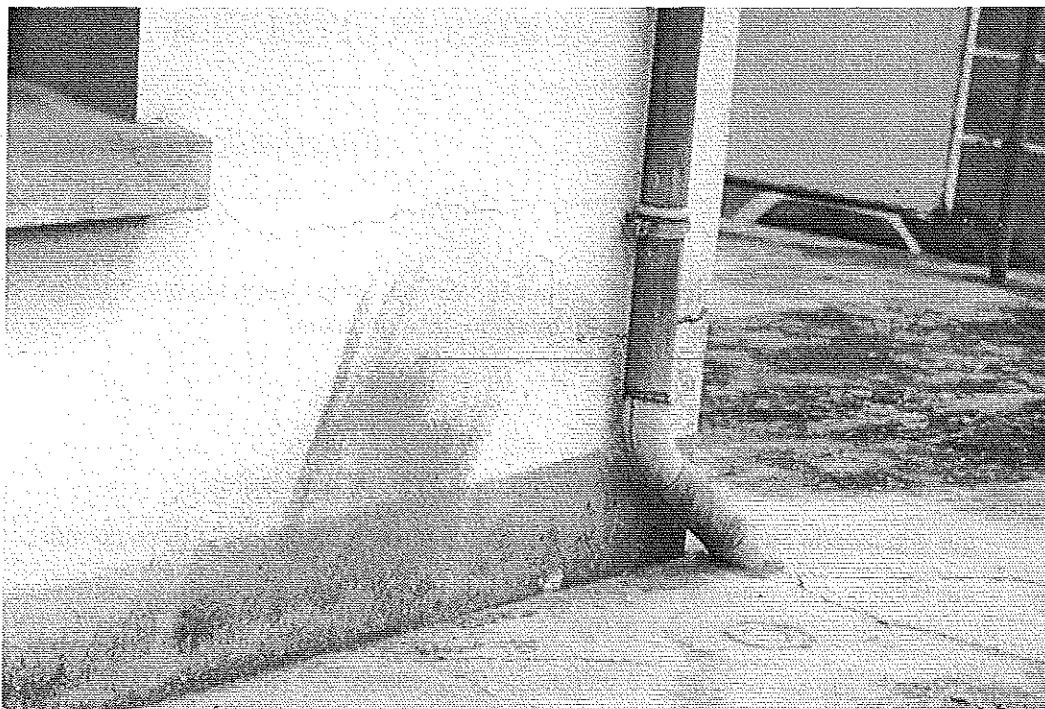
Retour de façade. La fissure se poursuit et rejoint l'appui de baie après un décrochement vertical. Noter la fissuration du dallage autour de l'évacuation des eaux pluviales. © J. Putatti
